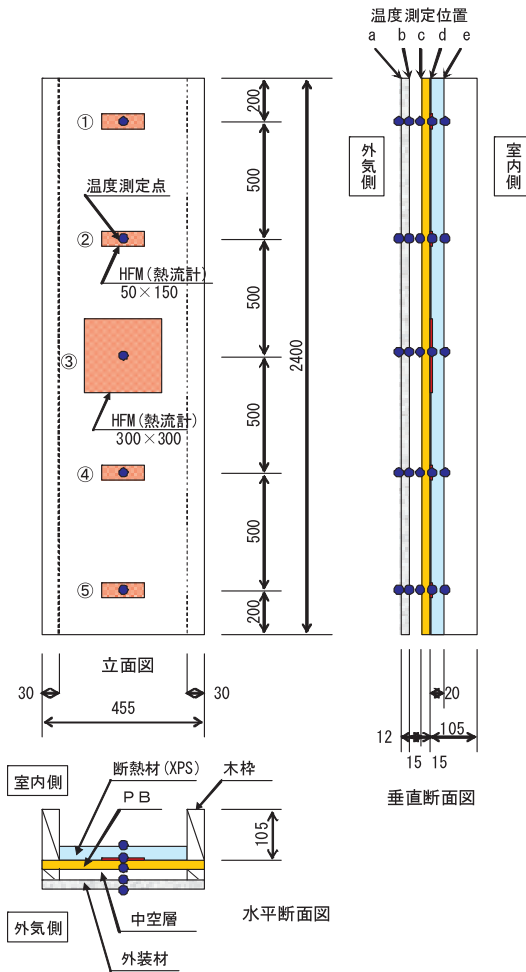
外壁モデルの構造・寸法 (寸法単位: mm)
